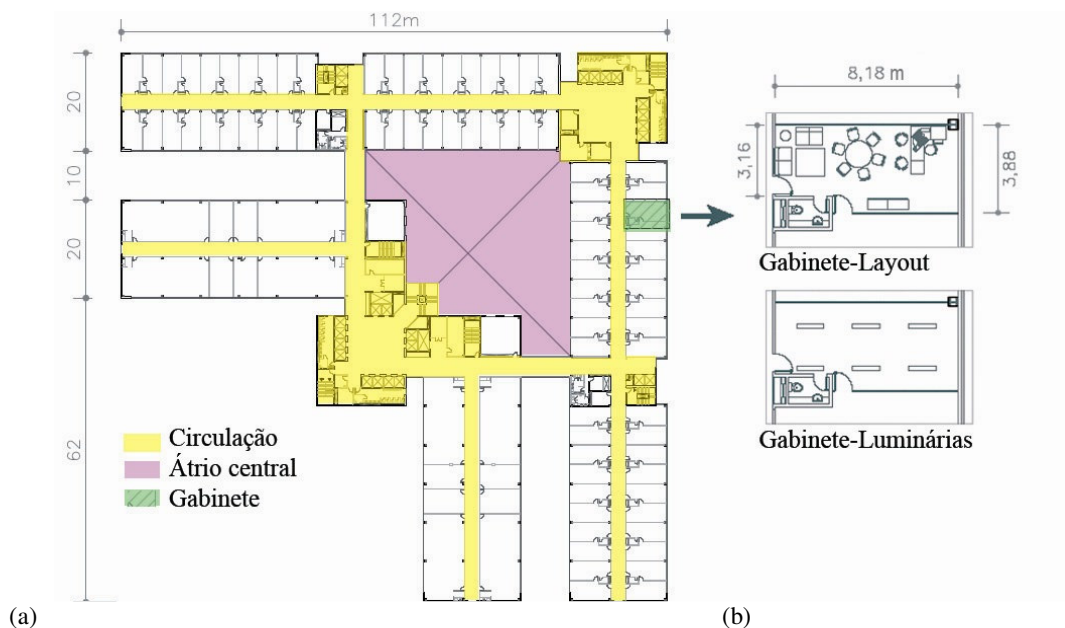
Plantas do pavimento-tipo e do ambiente em análise: (a) Planta do pavimento-tipo mostrando o átrio central, as circulações e o ambiente de análise repetido ao longo das torres externas; (b) Planta do ambiente-tipo em análise com layout e, abaixo, demonstrando a distribuição das luminárias. Ambas sem escala, com medidas em metros. Fonte: Adaptado de arquivos cedidos pelo TJMG.
